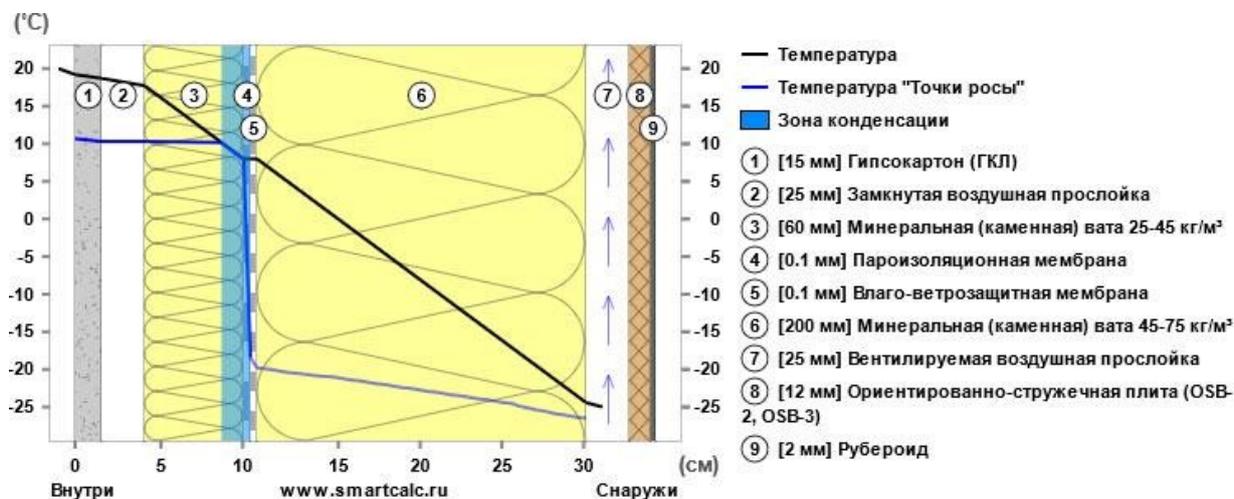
Зоны конденсации водяного пара в исследуемой строительной конструкции кровли по предварительному теплотехническому расчету с вентилируемой воздушной прослойкой, обеспечивающей надлежащую вентиляцию пространства между утеплителем и ОСП
